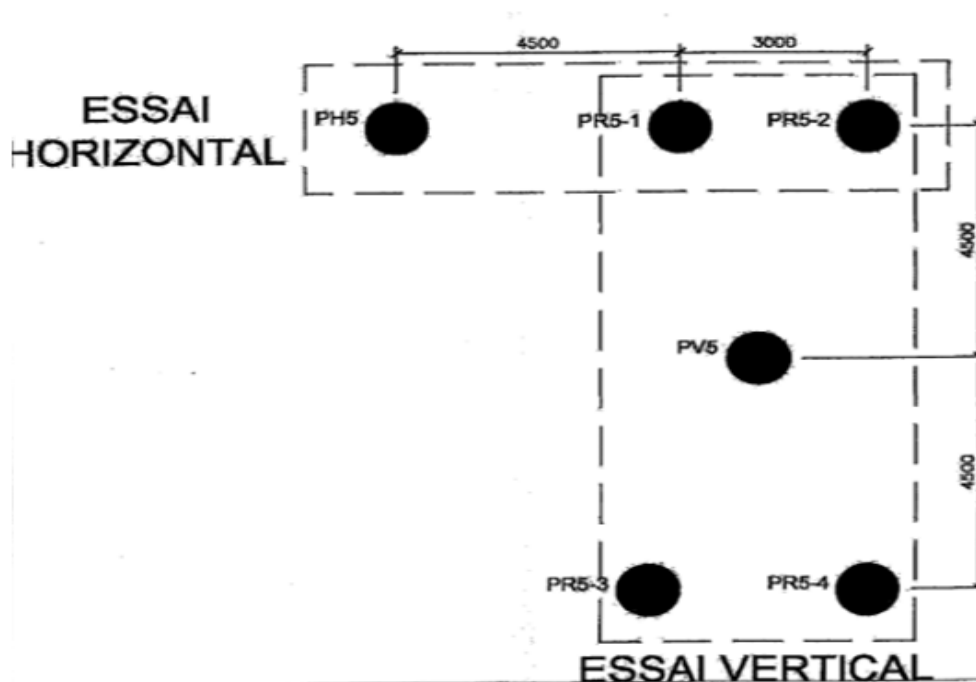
vue en plan de pieu d'essai PV5-PH5.
